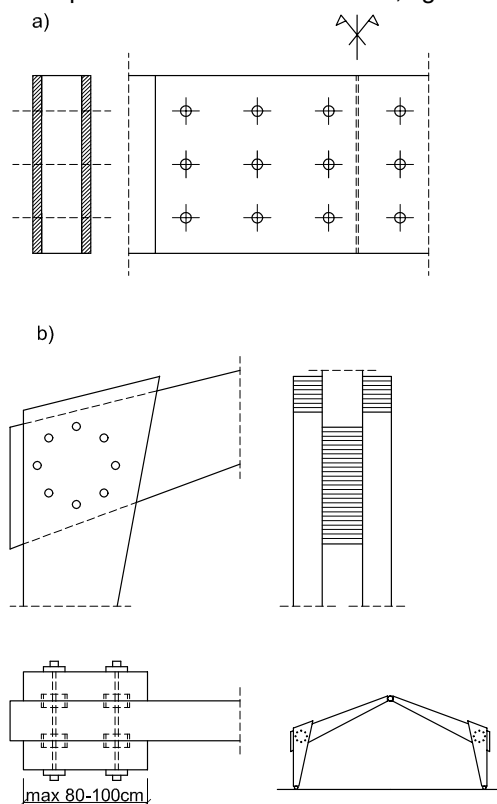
a), b) y c). Ejemplos de detalles constructivos de protección de elementos estructurales.
